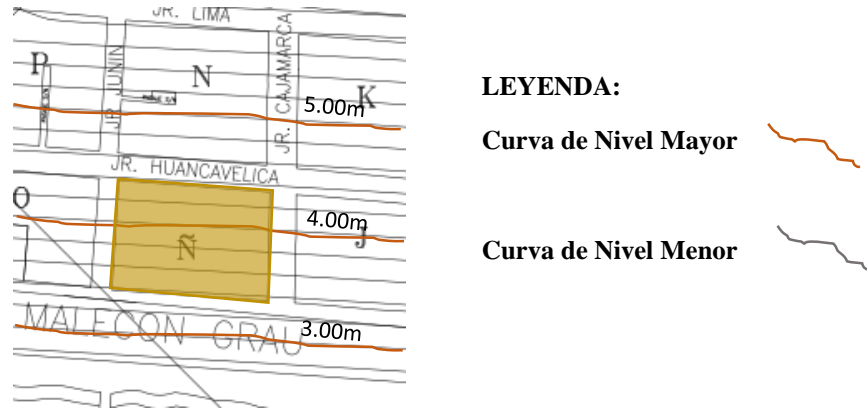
Vista del Nivel Topográfico del terreno de la Mz.Ñ
